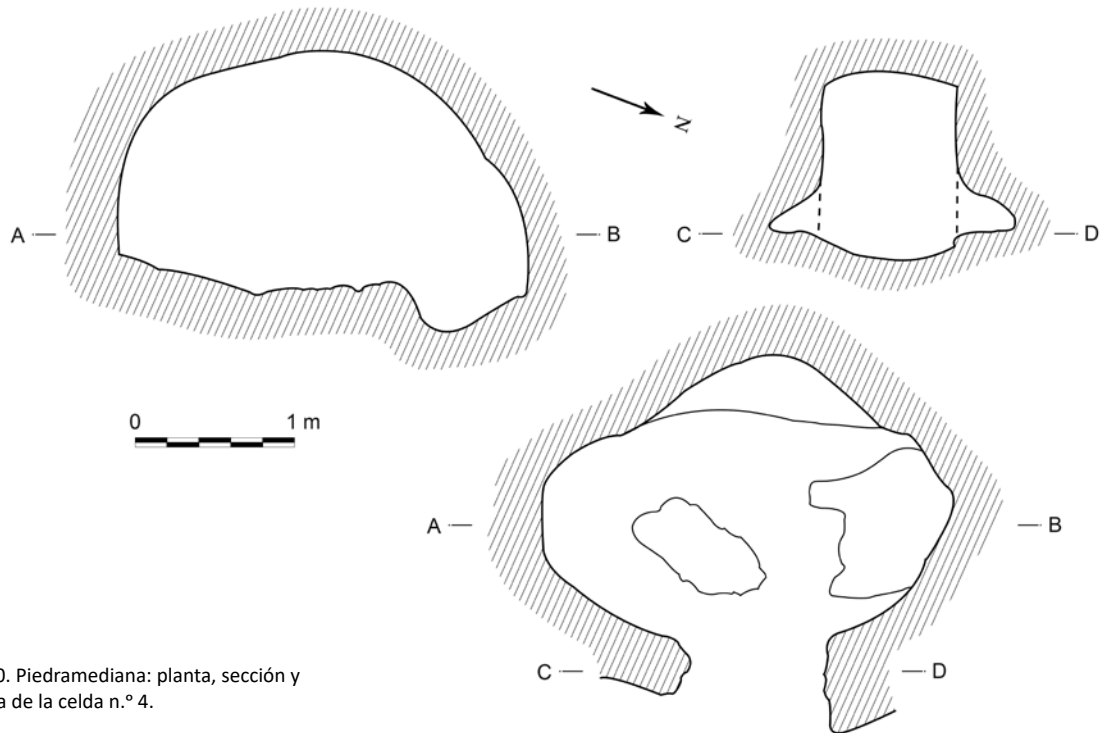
Piedramediana: planta, sección y puerta de la celda n.º 4.
